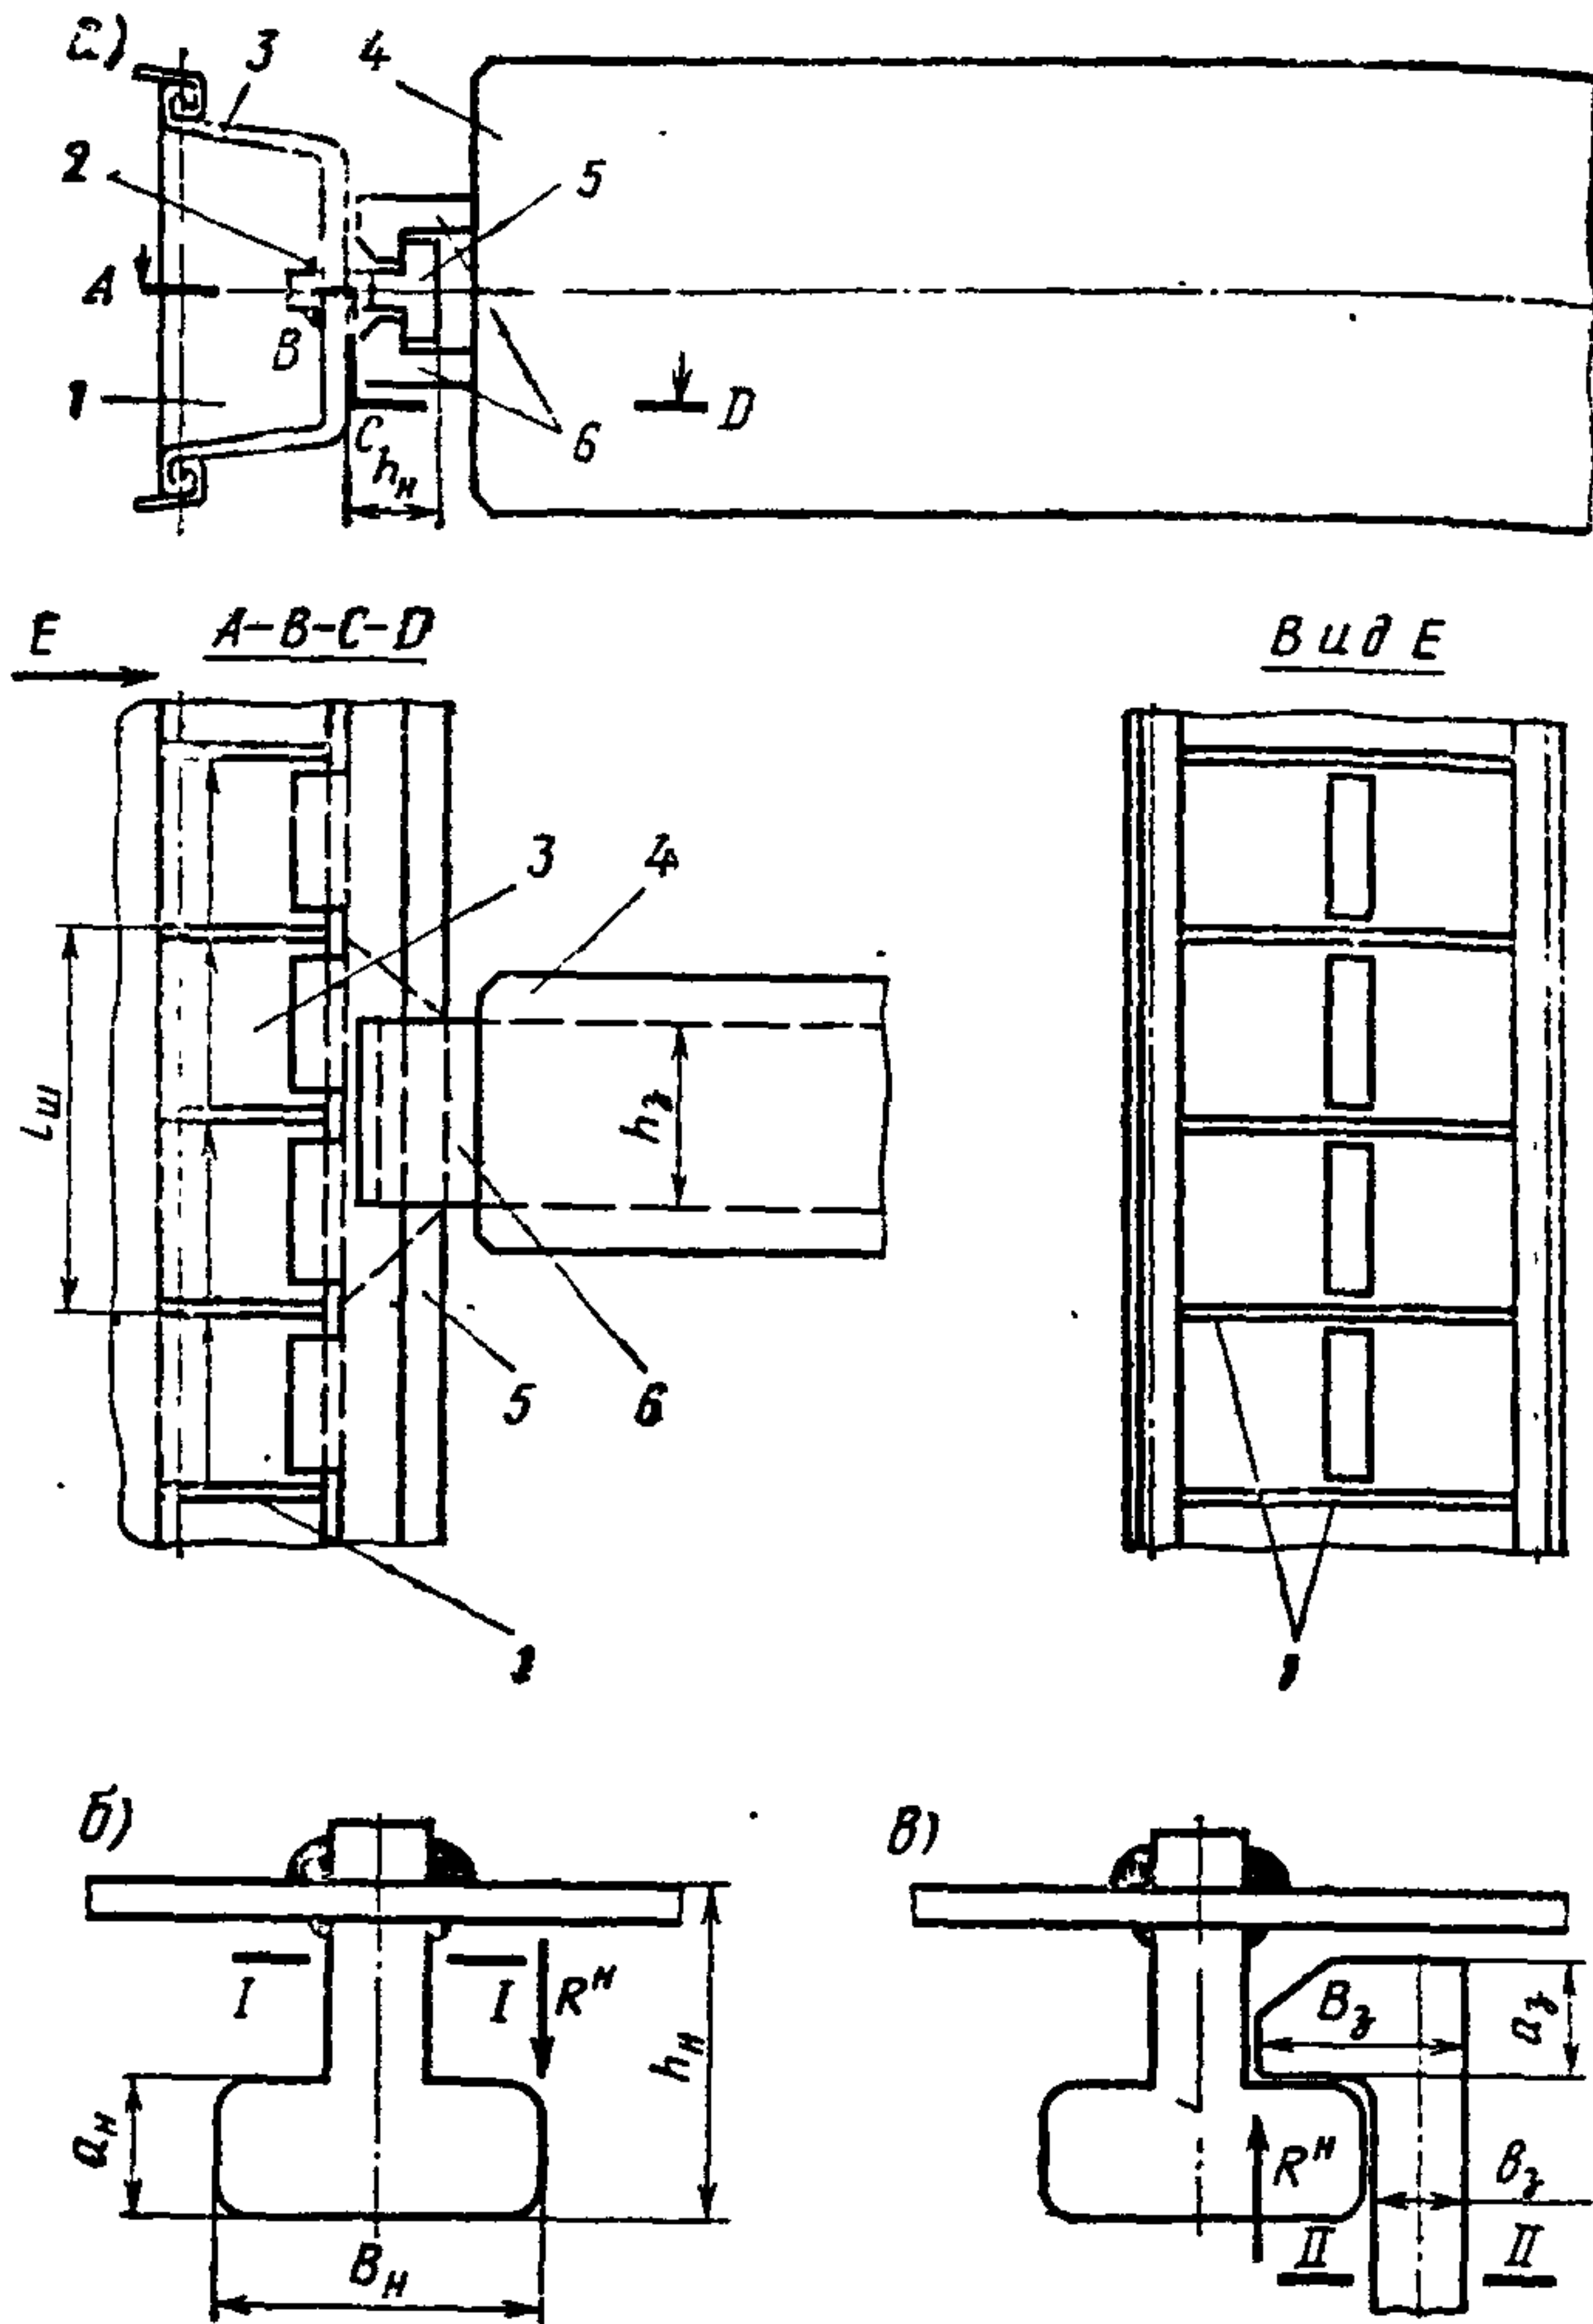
Крепление анкерной плиты к шпунтовой стенке с помощью сварки:
